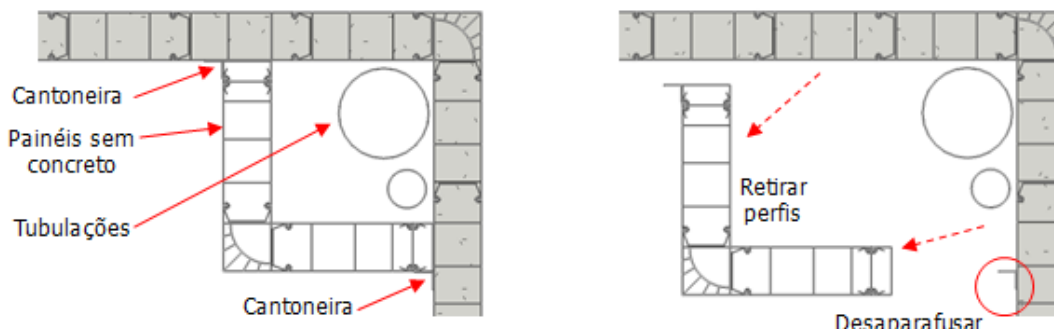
Exemplo de shaft construídos com os perfis de PVC rígido do Sistema Construtivo Basse PVC. (Sem escala).
